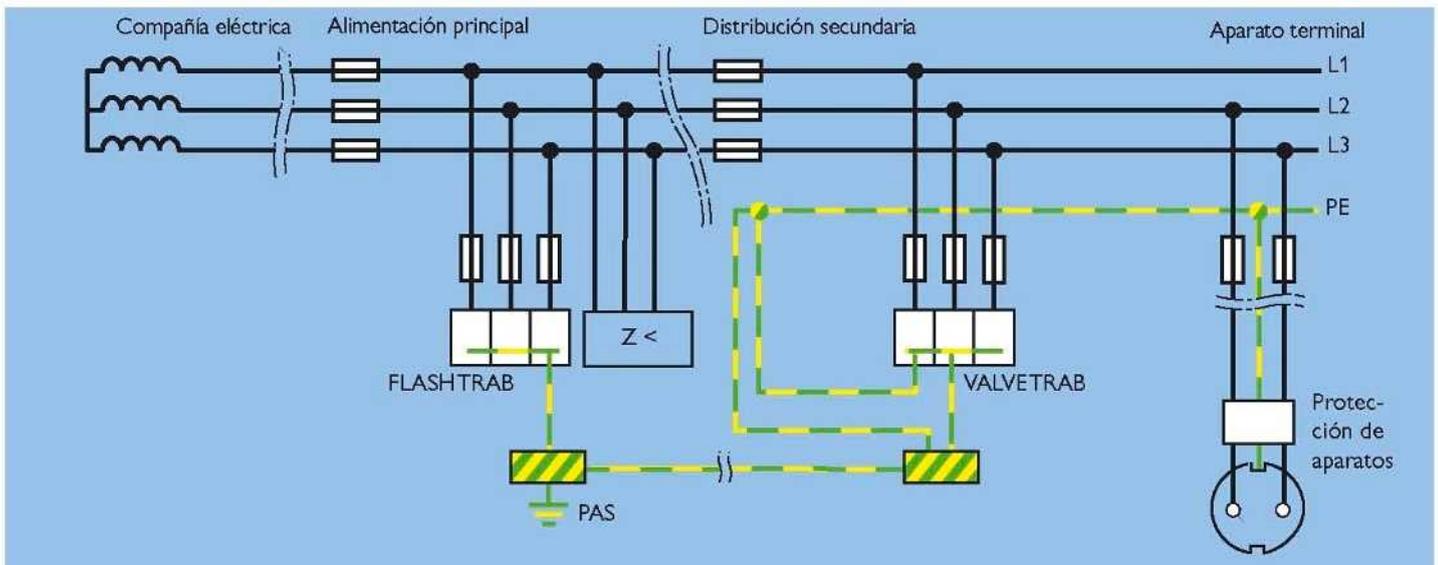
Sistema IT con dispositivo de vigilancia de aislamiento (de conductor de protección a tierra)
